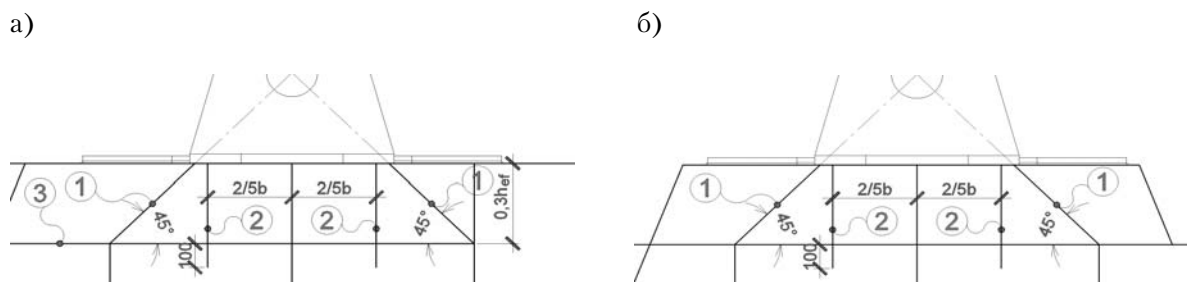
Конструктивные схемы расположения ребёр жёсткости для двух видов узлов: а) на верхнюю полку подшипивной конструкции; б) на дополнительный элемент в виде тавра; b – ширина подшипника шкива; h_{ef} – высота стенки балки; 1 – наклонное двустороннее ребро; 2 – вертикальное двустороннее ребро; 3 – горизонтальное двустороннее ребро.
